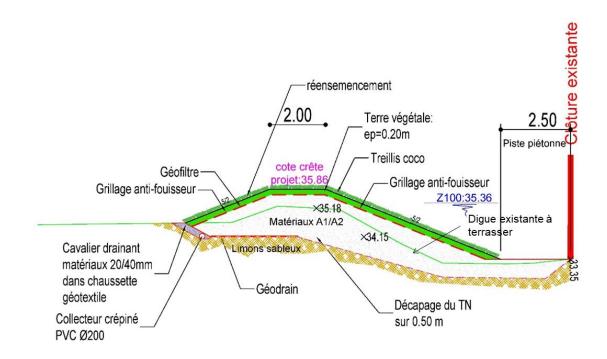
Profil en travers de la digue 1 au PK 100
